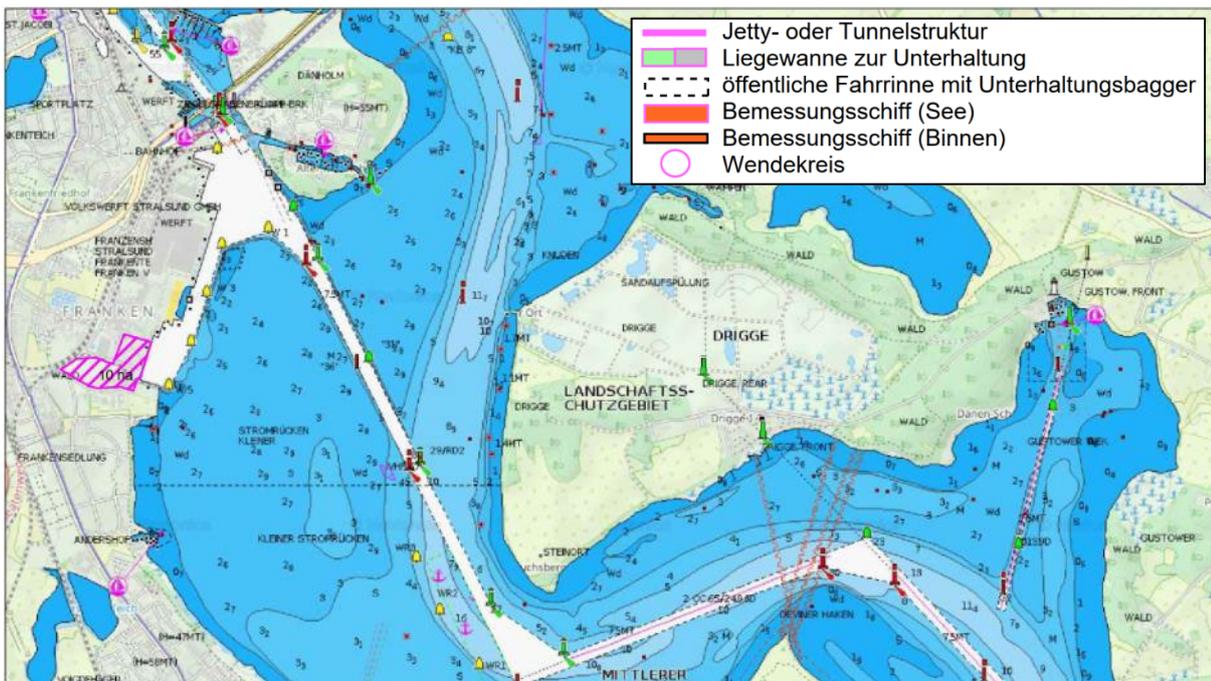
Lageplan Alternative 15: Stralsund²⁰¹
